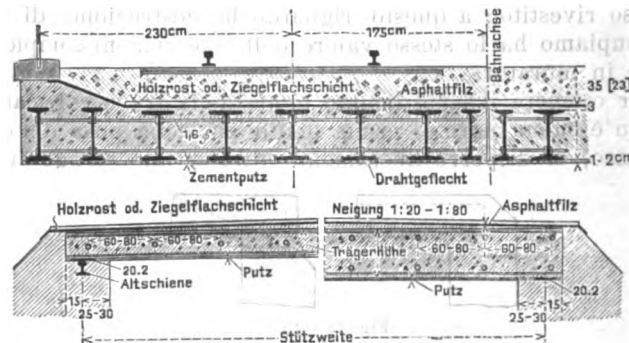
e 11. — Tipo di struttura di ponte in travi e calcestruzzo. Spiegazione dei termini tedeschi: Bahnachse asse della linea. Holzrost oder Ziegelflächenschicht: traliccio di legno a piattaforma di mattoni. Zementputz: intonaco di cemento. Drahtgeflecht: rete metallica. Asphaltfilz: copertura d'asfalto. Altschiene: vecchio rotaia. Putz: intonaco.
